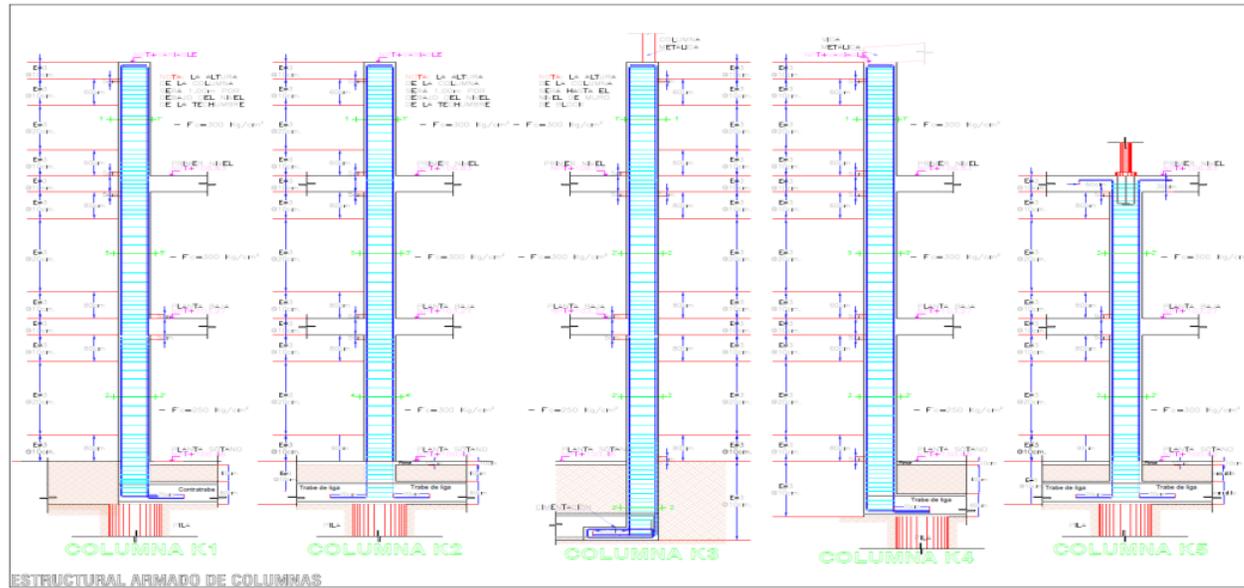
Plano de armado de columnas según su tipo y separación de estribos en alzado.
